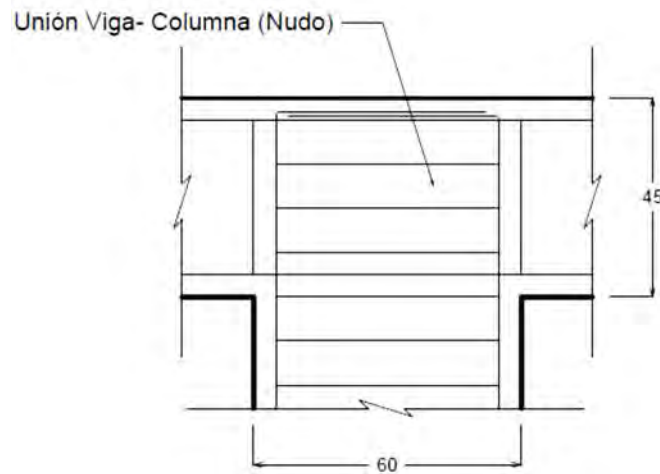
Detalle de nudo viga-columna (López 2011)
